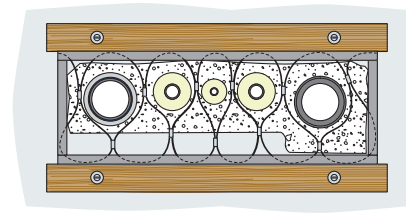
Ungleichmäßiger Deckendurchbruch mit Belegung und Deckenschott FSH90 unterhalb der Decke montiert
